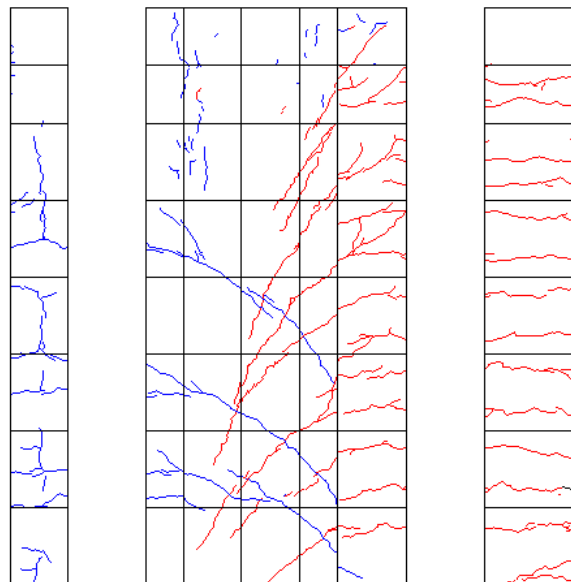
R=1/133②ひび割れ図
